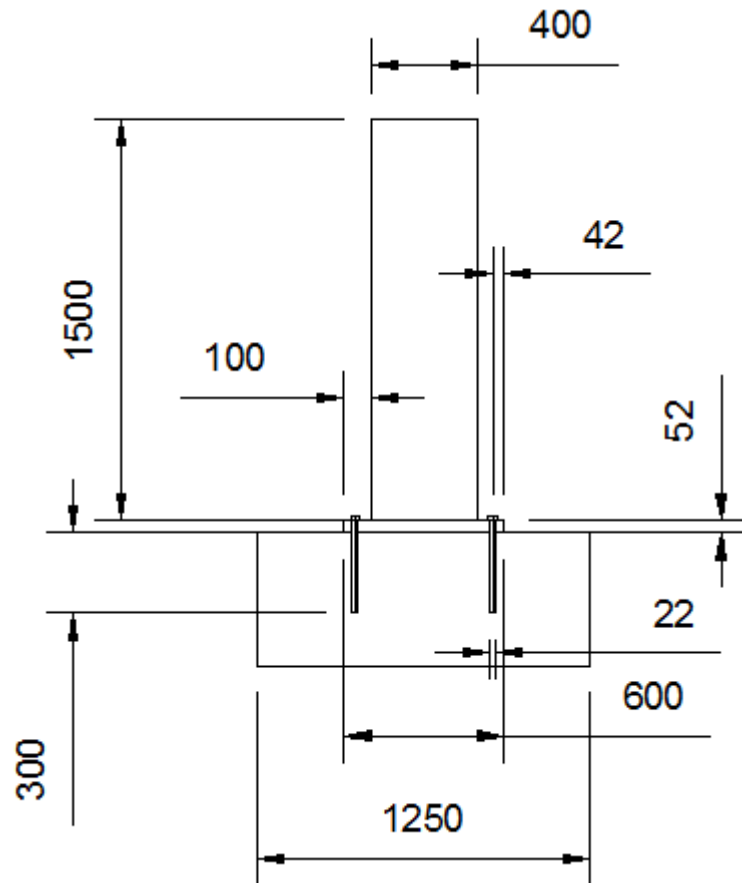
Vista frontal conexión columna tubular rectangular compuesta a cimentación con placa base emperrada. Conexión 3. (Dimensiones en *mm*)
